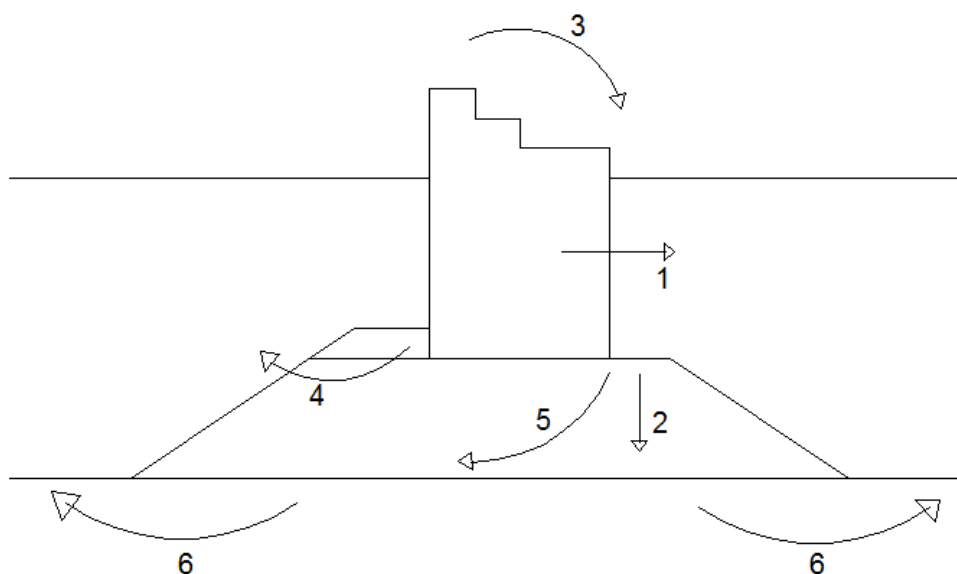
Principais modos de rotura de um quebramar vertical (1 – deslizamento, 2 – afundamento da estrutura vertical, 3 – derrube, 4 – infraescavação, 5 – rotação da estrutura vertical, 6 – colapso da fundação).
